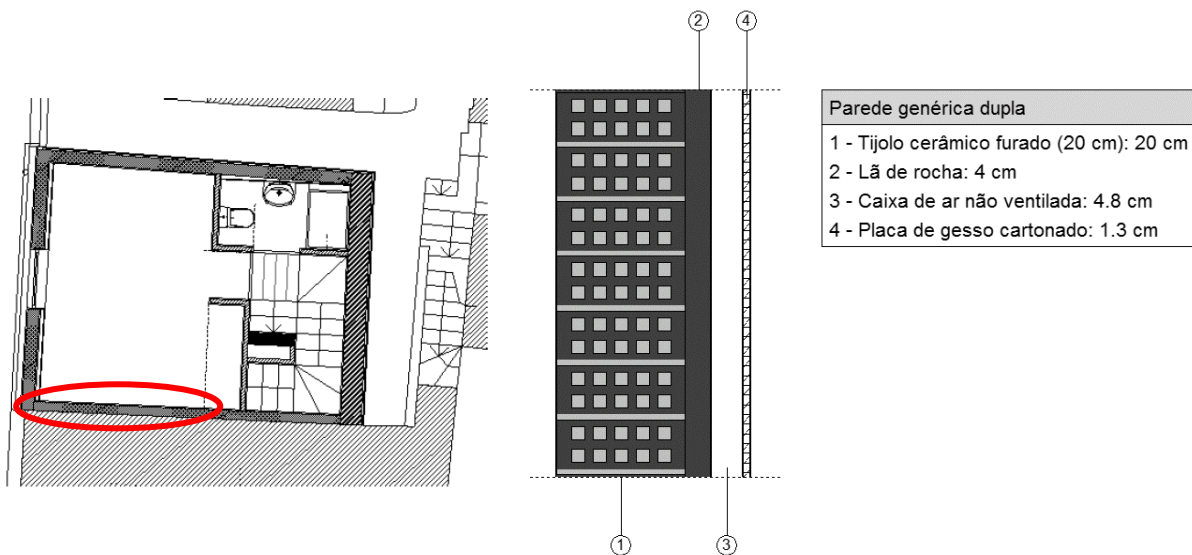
Identificação e pormenor construtivo da parede Pm1.
